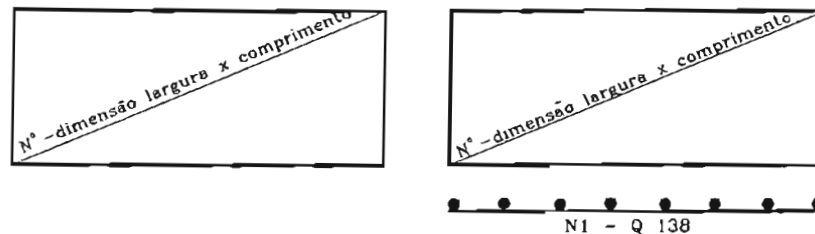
Simbologia de tela soldada para armadura simples
